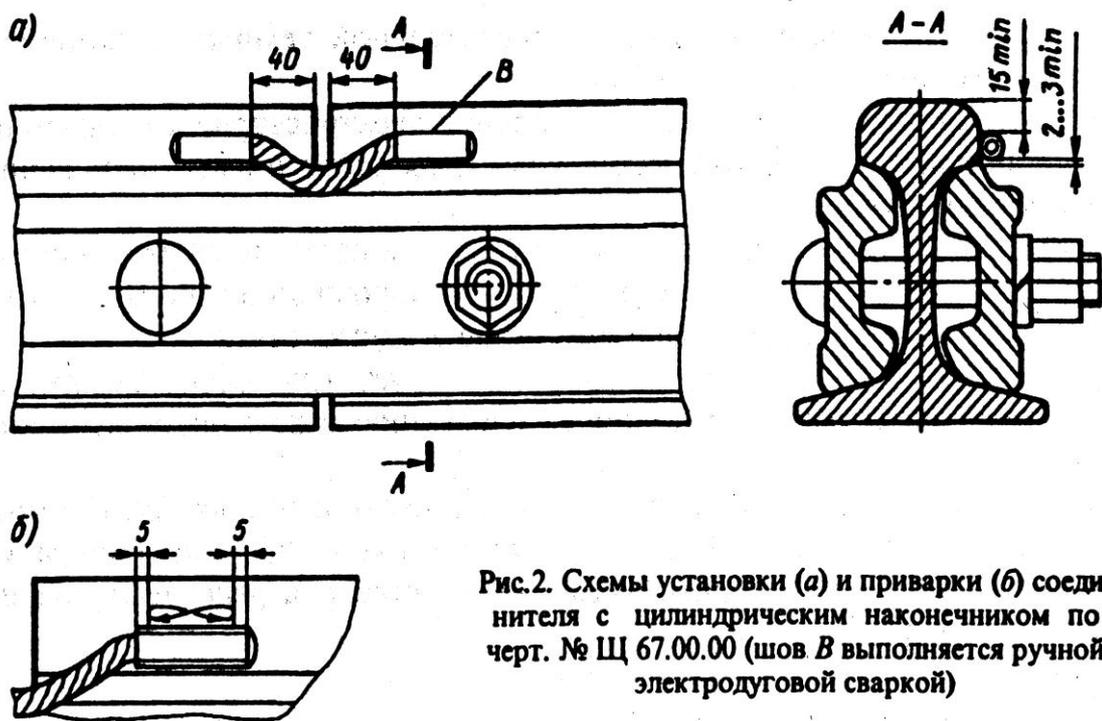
Схемы установки (а) и приварки (б) соединителя с цилиндрическим наконечником по черт. № Щ 67.00.00 (шов В выполняется ручной электродуговой сваркой)
